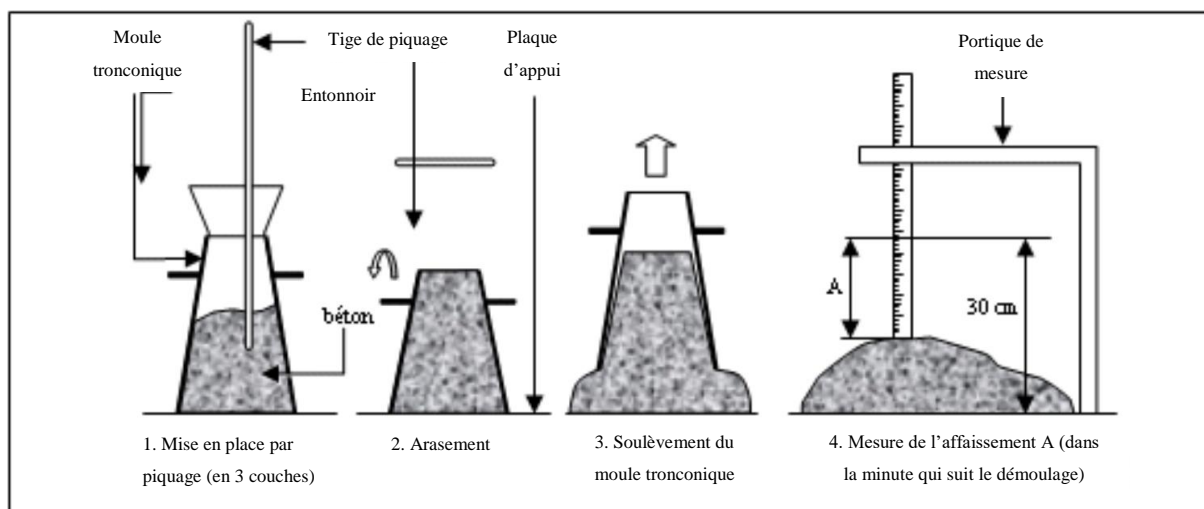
Essai d'affaissement au cône d'ABRAMS
